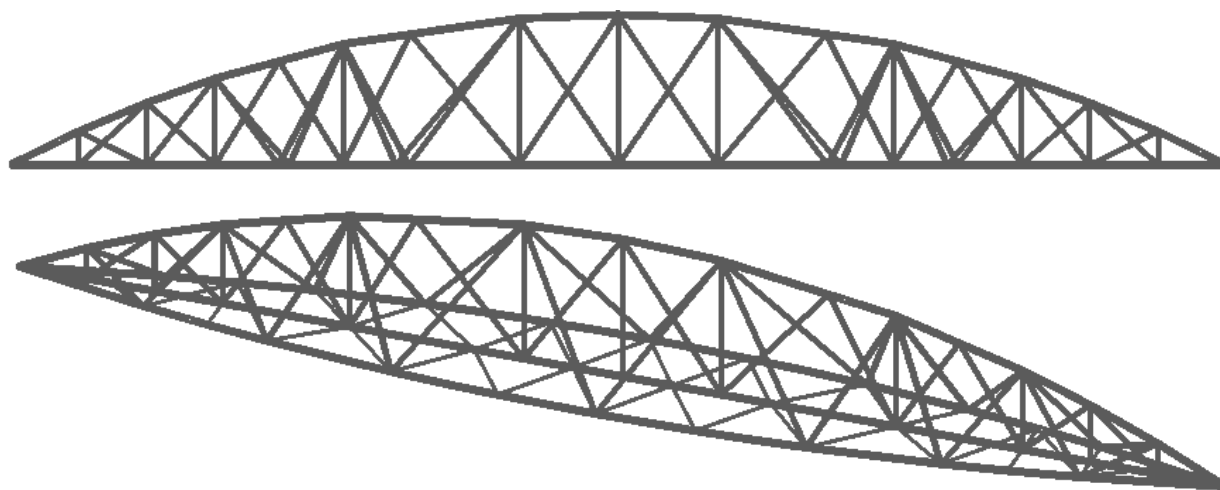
Решетка фермы 2-го варианта
